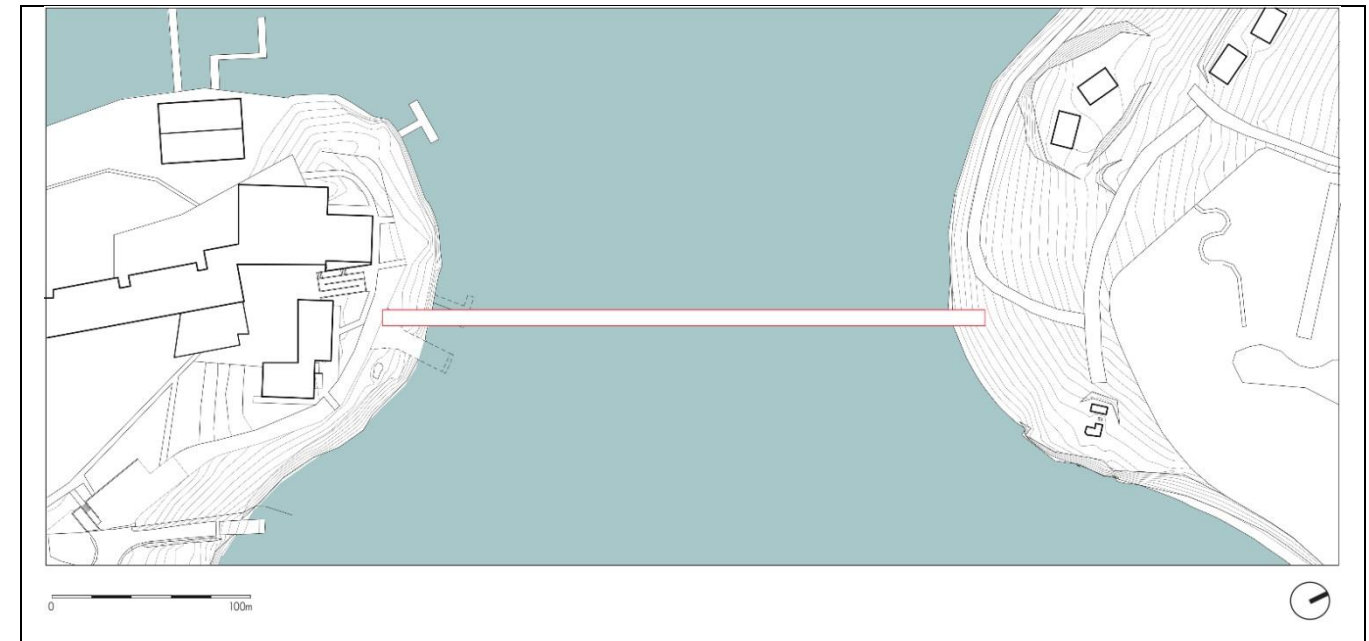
Vue en plan de l'implantation de la future passerelle, largeur libre 3,00 m
